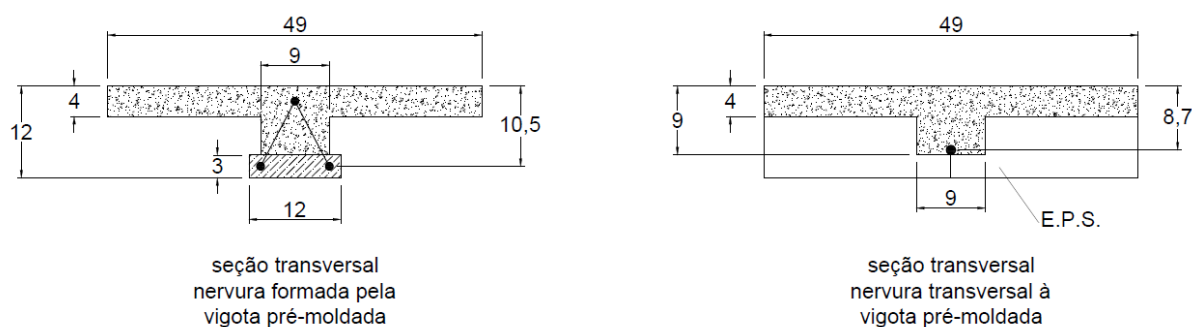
Geometria da laje ensaiada por Droppa Jr.
